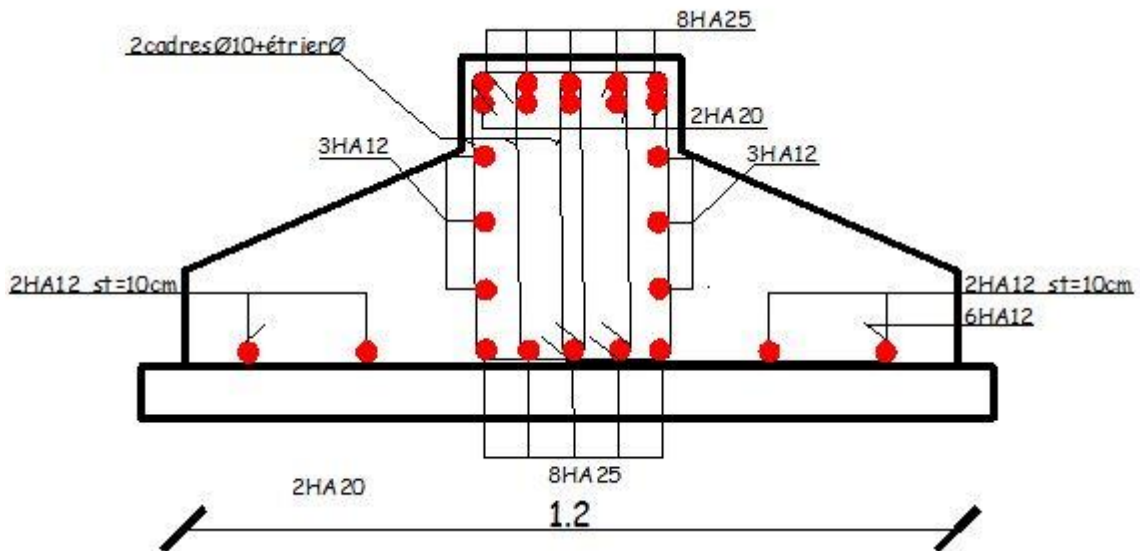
schéma de ferrailage de la semelle filante en travée (coupe transversale B-B').
